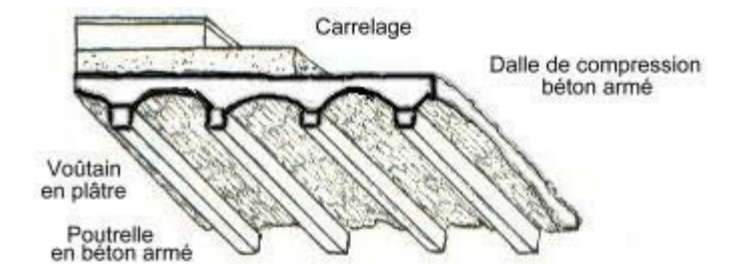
plancher voutain en plâtre structure poteau-poutre.
